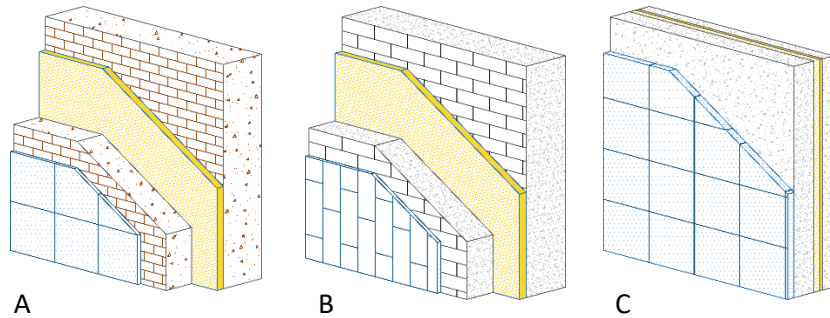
Fachadas macizas con acabado exterior discontinuo.
